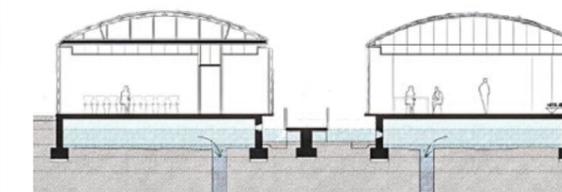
Fotografía centro de interpretación de AG. Elaborado por: autores basados en fotografía de ArchDaily.
